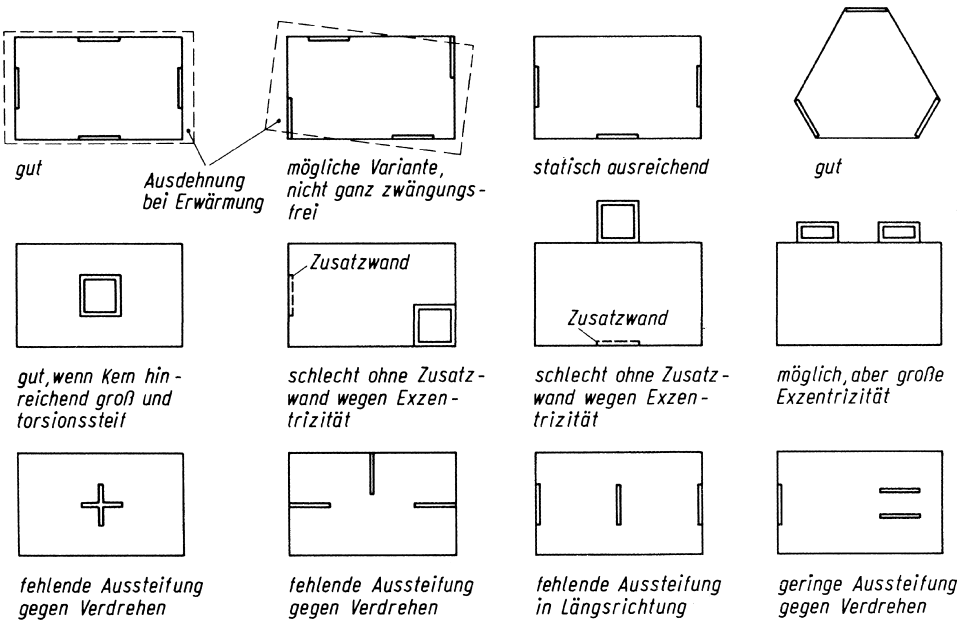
Anordnung der Gebäudeaussteifung im Grundriss
